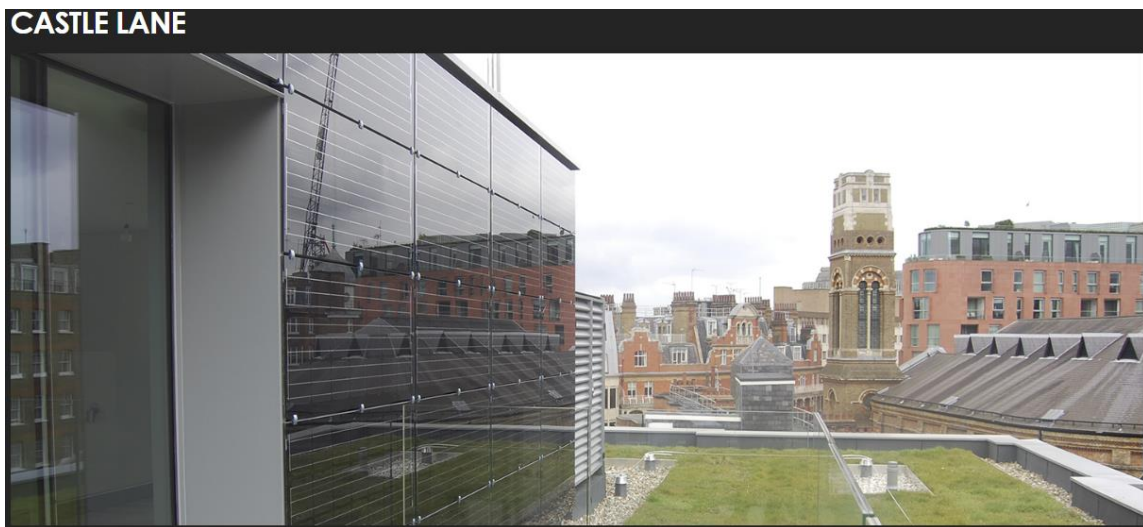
Fachada ventilada de edificio en Castle Lane [13]
